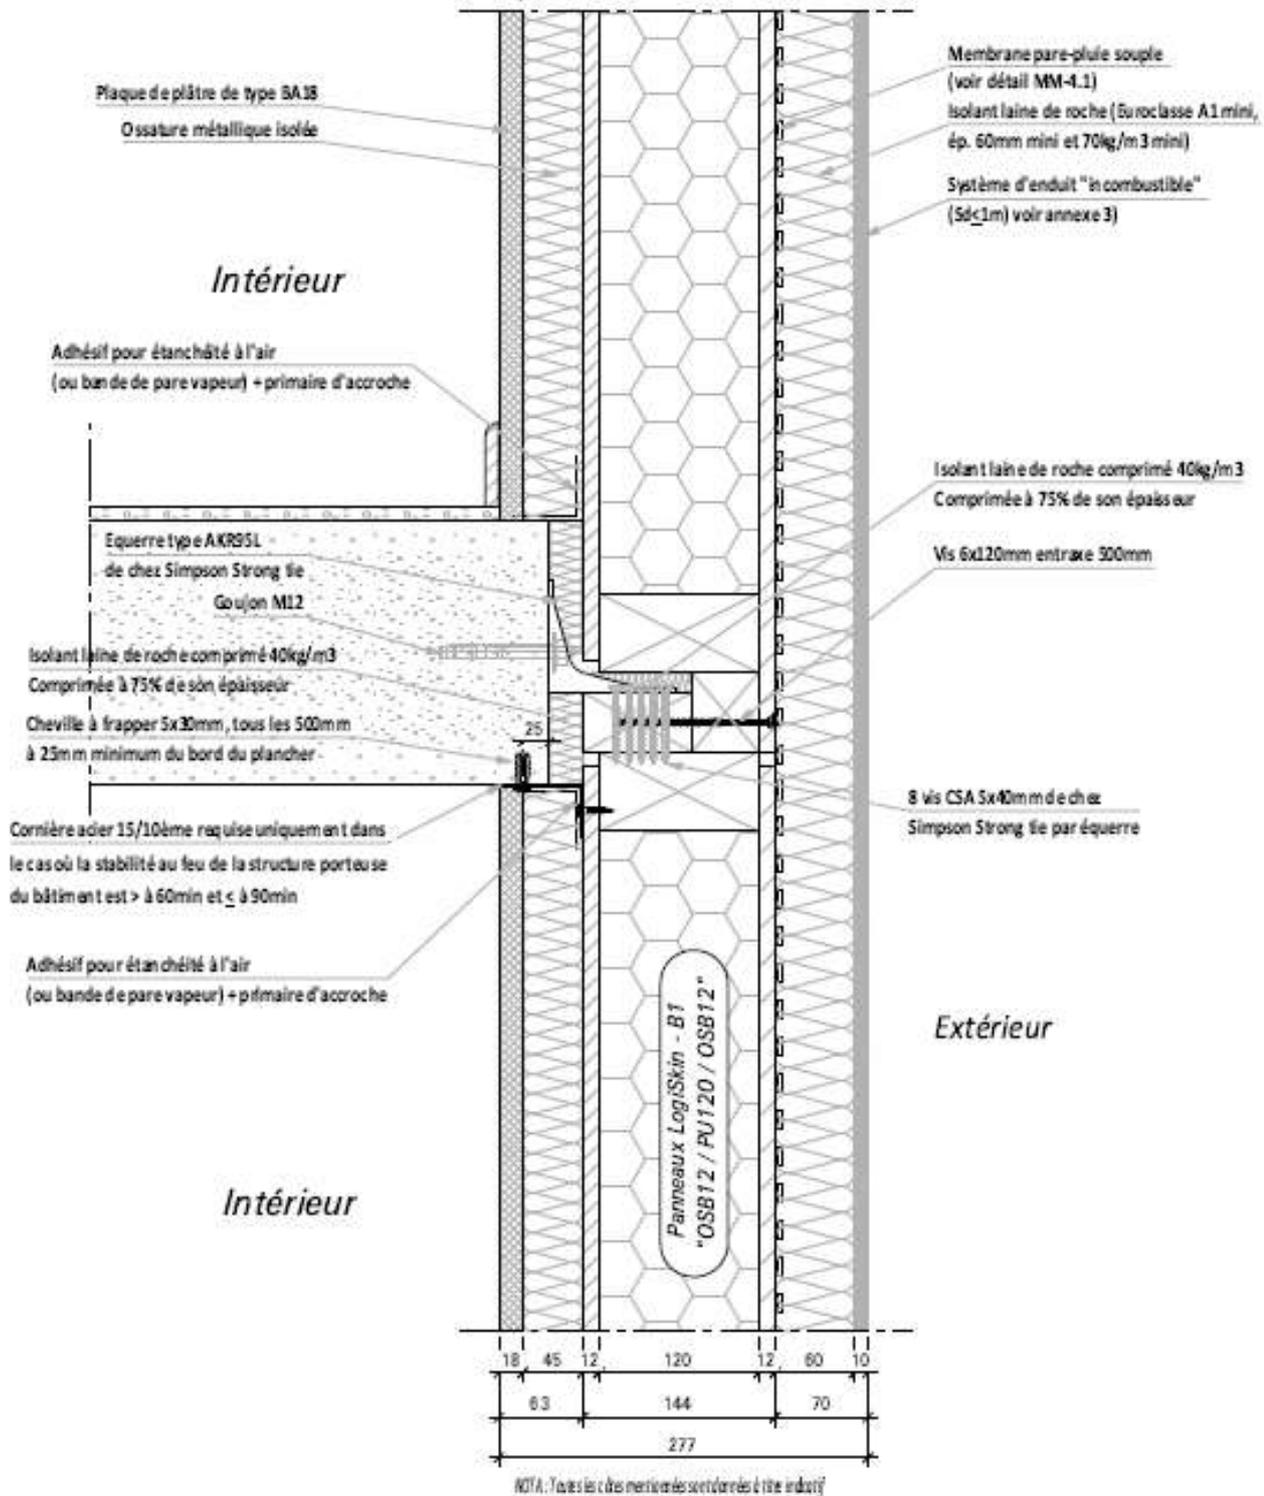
Détail CV-2.5 – jonction avec plancher (mode de pose 1)
